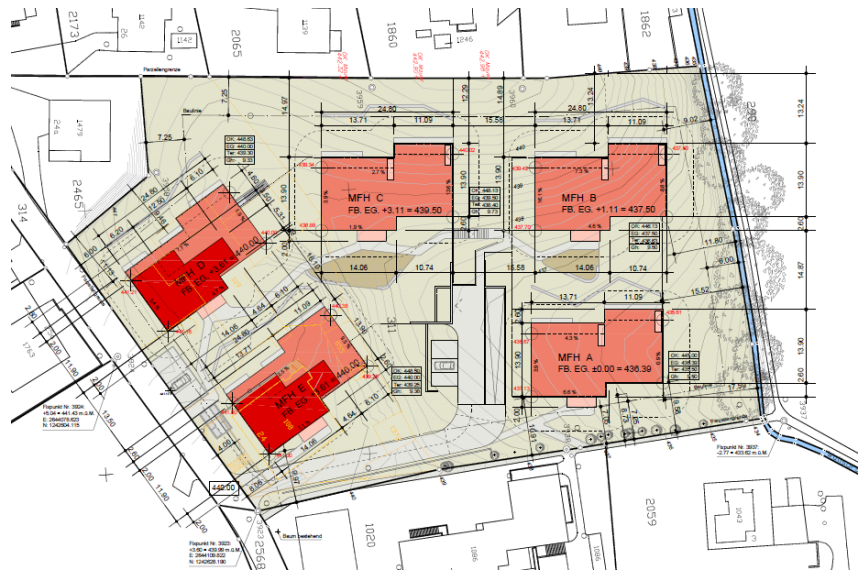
Situationsplan (Norden ist rechts), Richtprojekt, Strebel Architektur, Zoffingen
